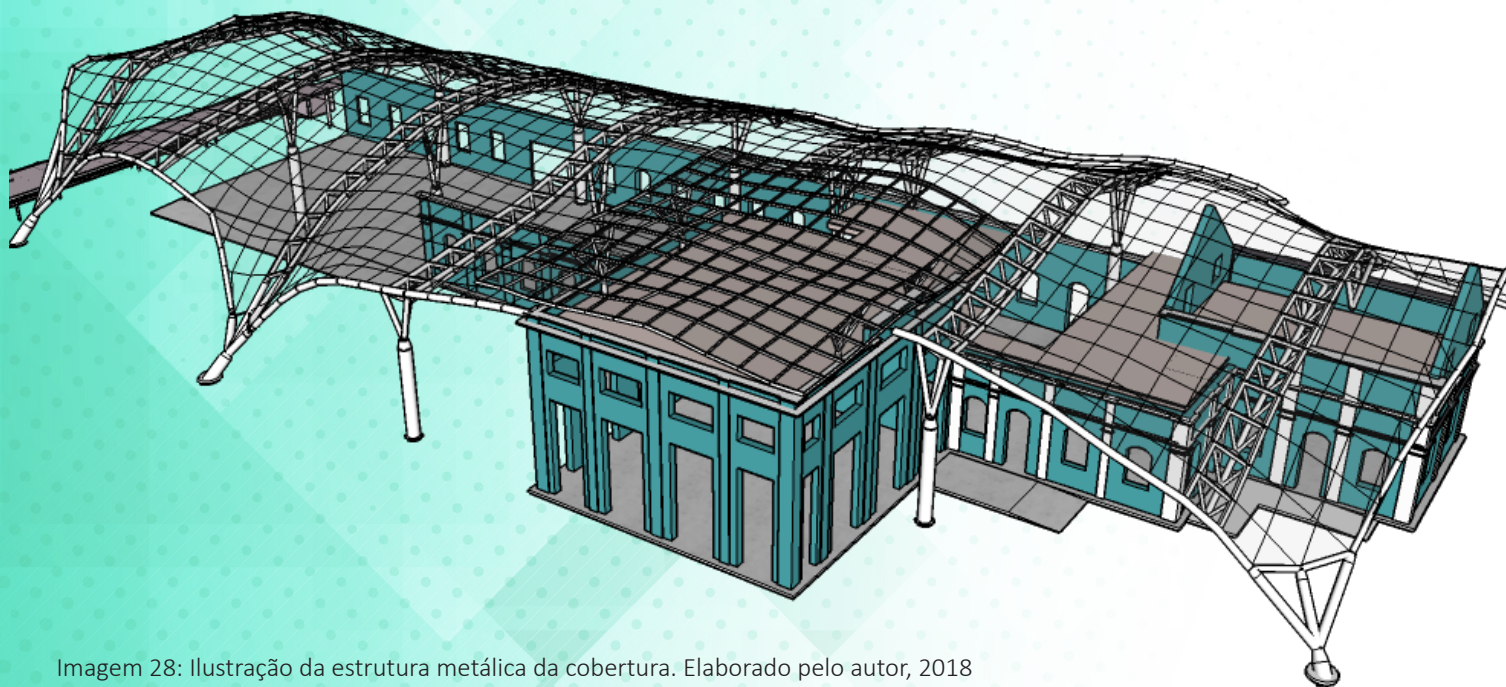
Ilustração da estrutura metálica da cobertura. Elaborado pelo autor, 2018
